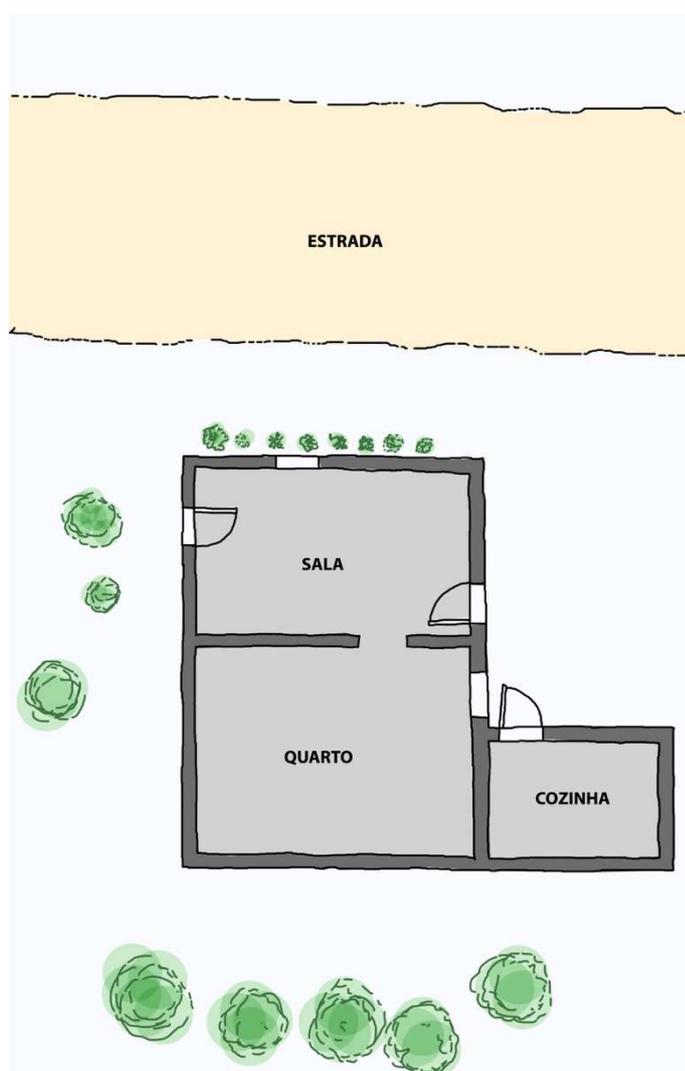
Esquema da planta baixa da casa de Michelle, sem escala.
